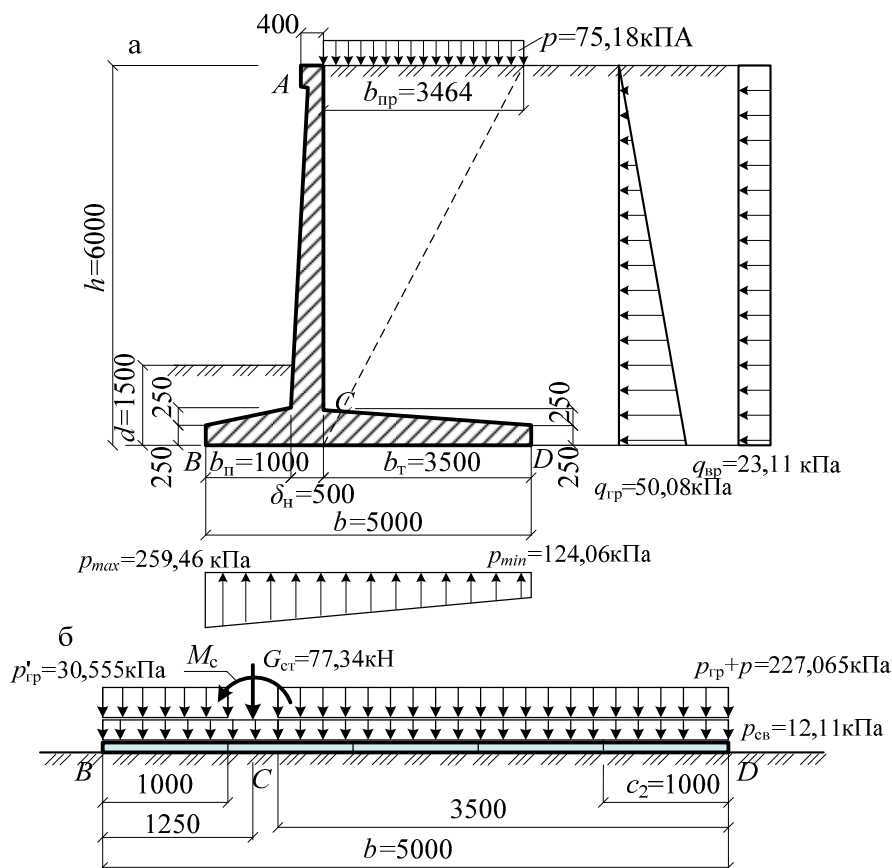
Нагрузки на подпорную стенку: а – на вертикальную стенку; б – на фундамент
